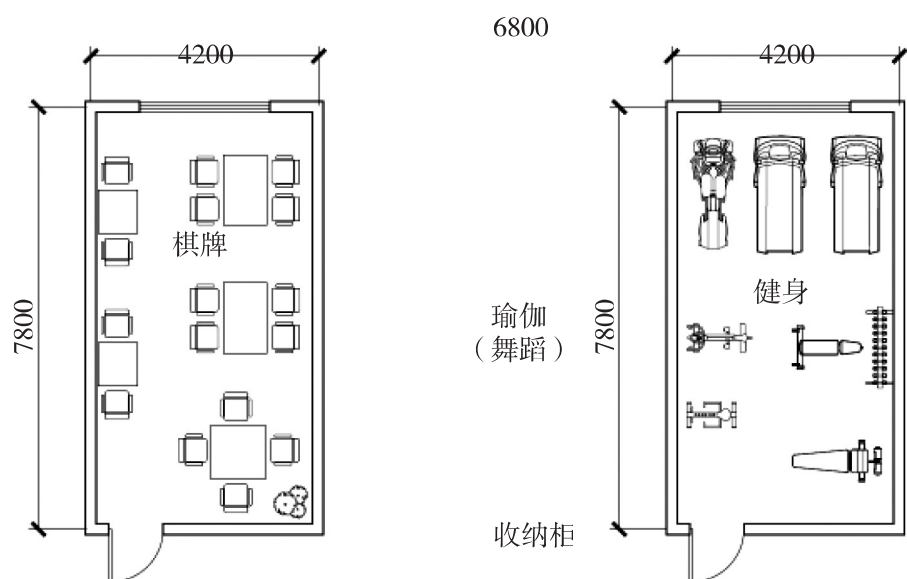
三类小文体活动室平面布局示意 (一) (mm)
